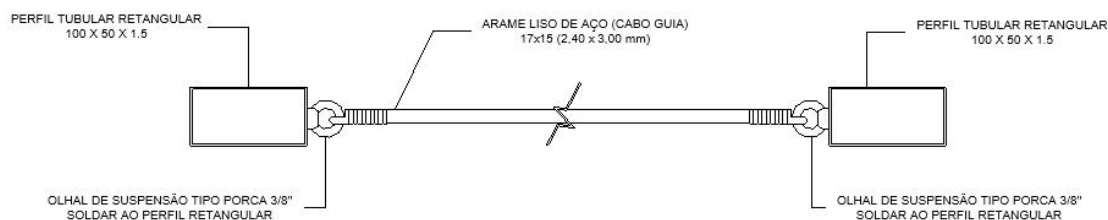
Detalhe da ligação entre cabo guia e perfil tubular.
